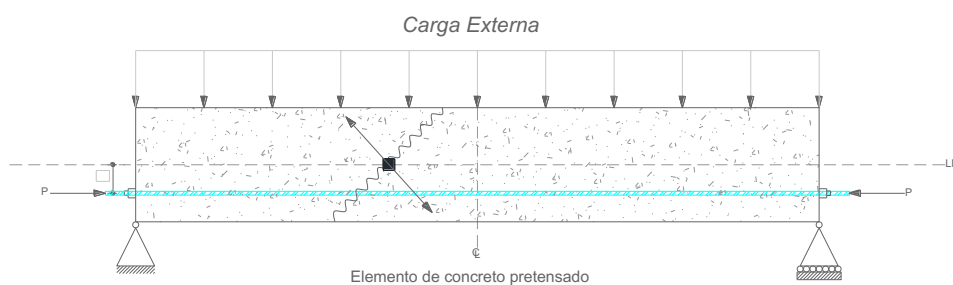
Grietas tendidas en el hormigón pretensado.
